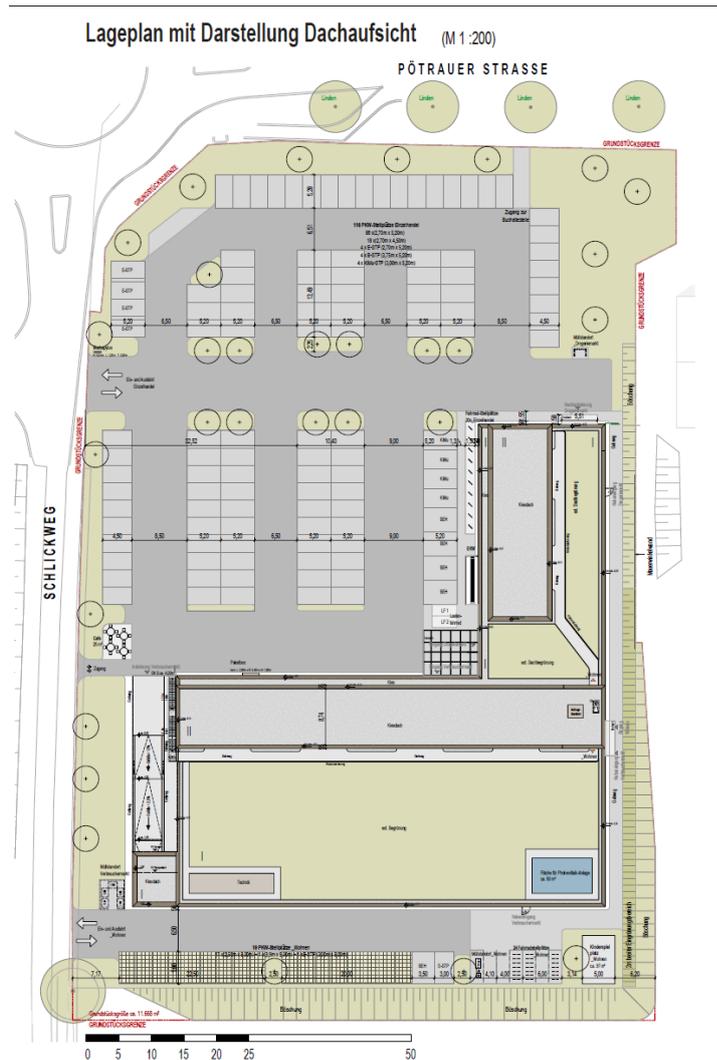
Lageplan Pötrauer Tor (SKAI-Architekten, Stand 21.01.2022)
